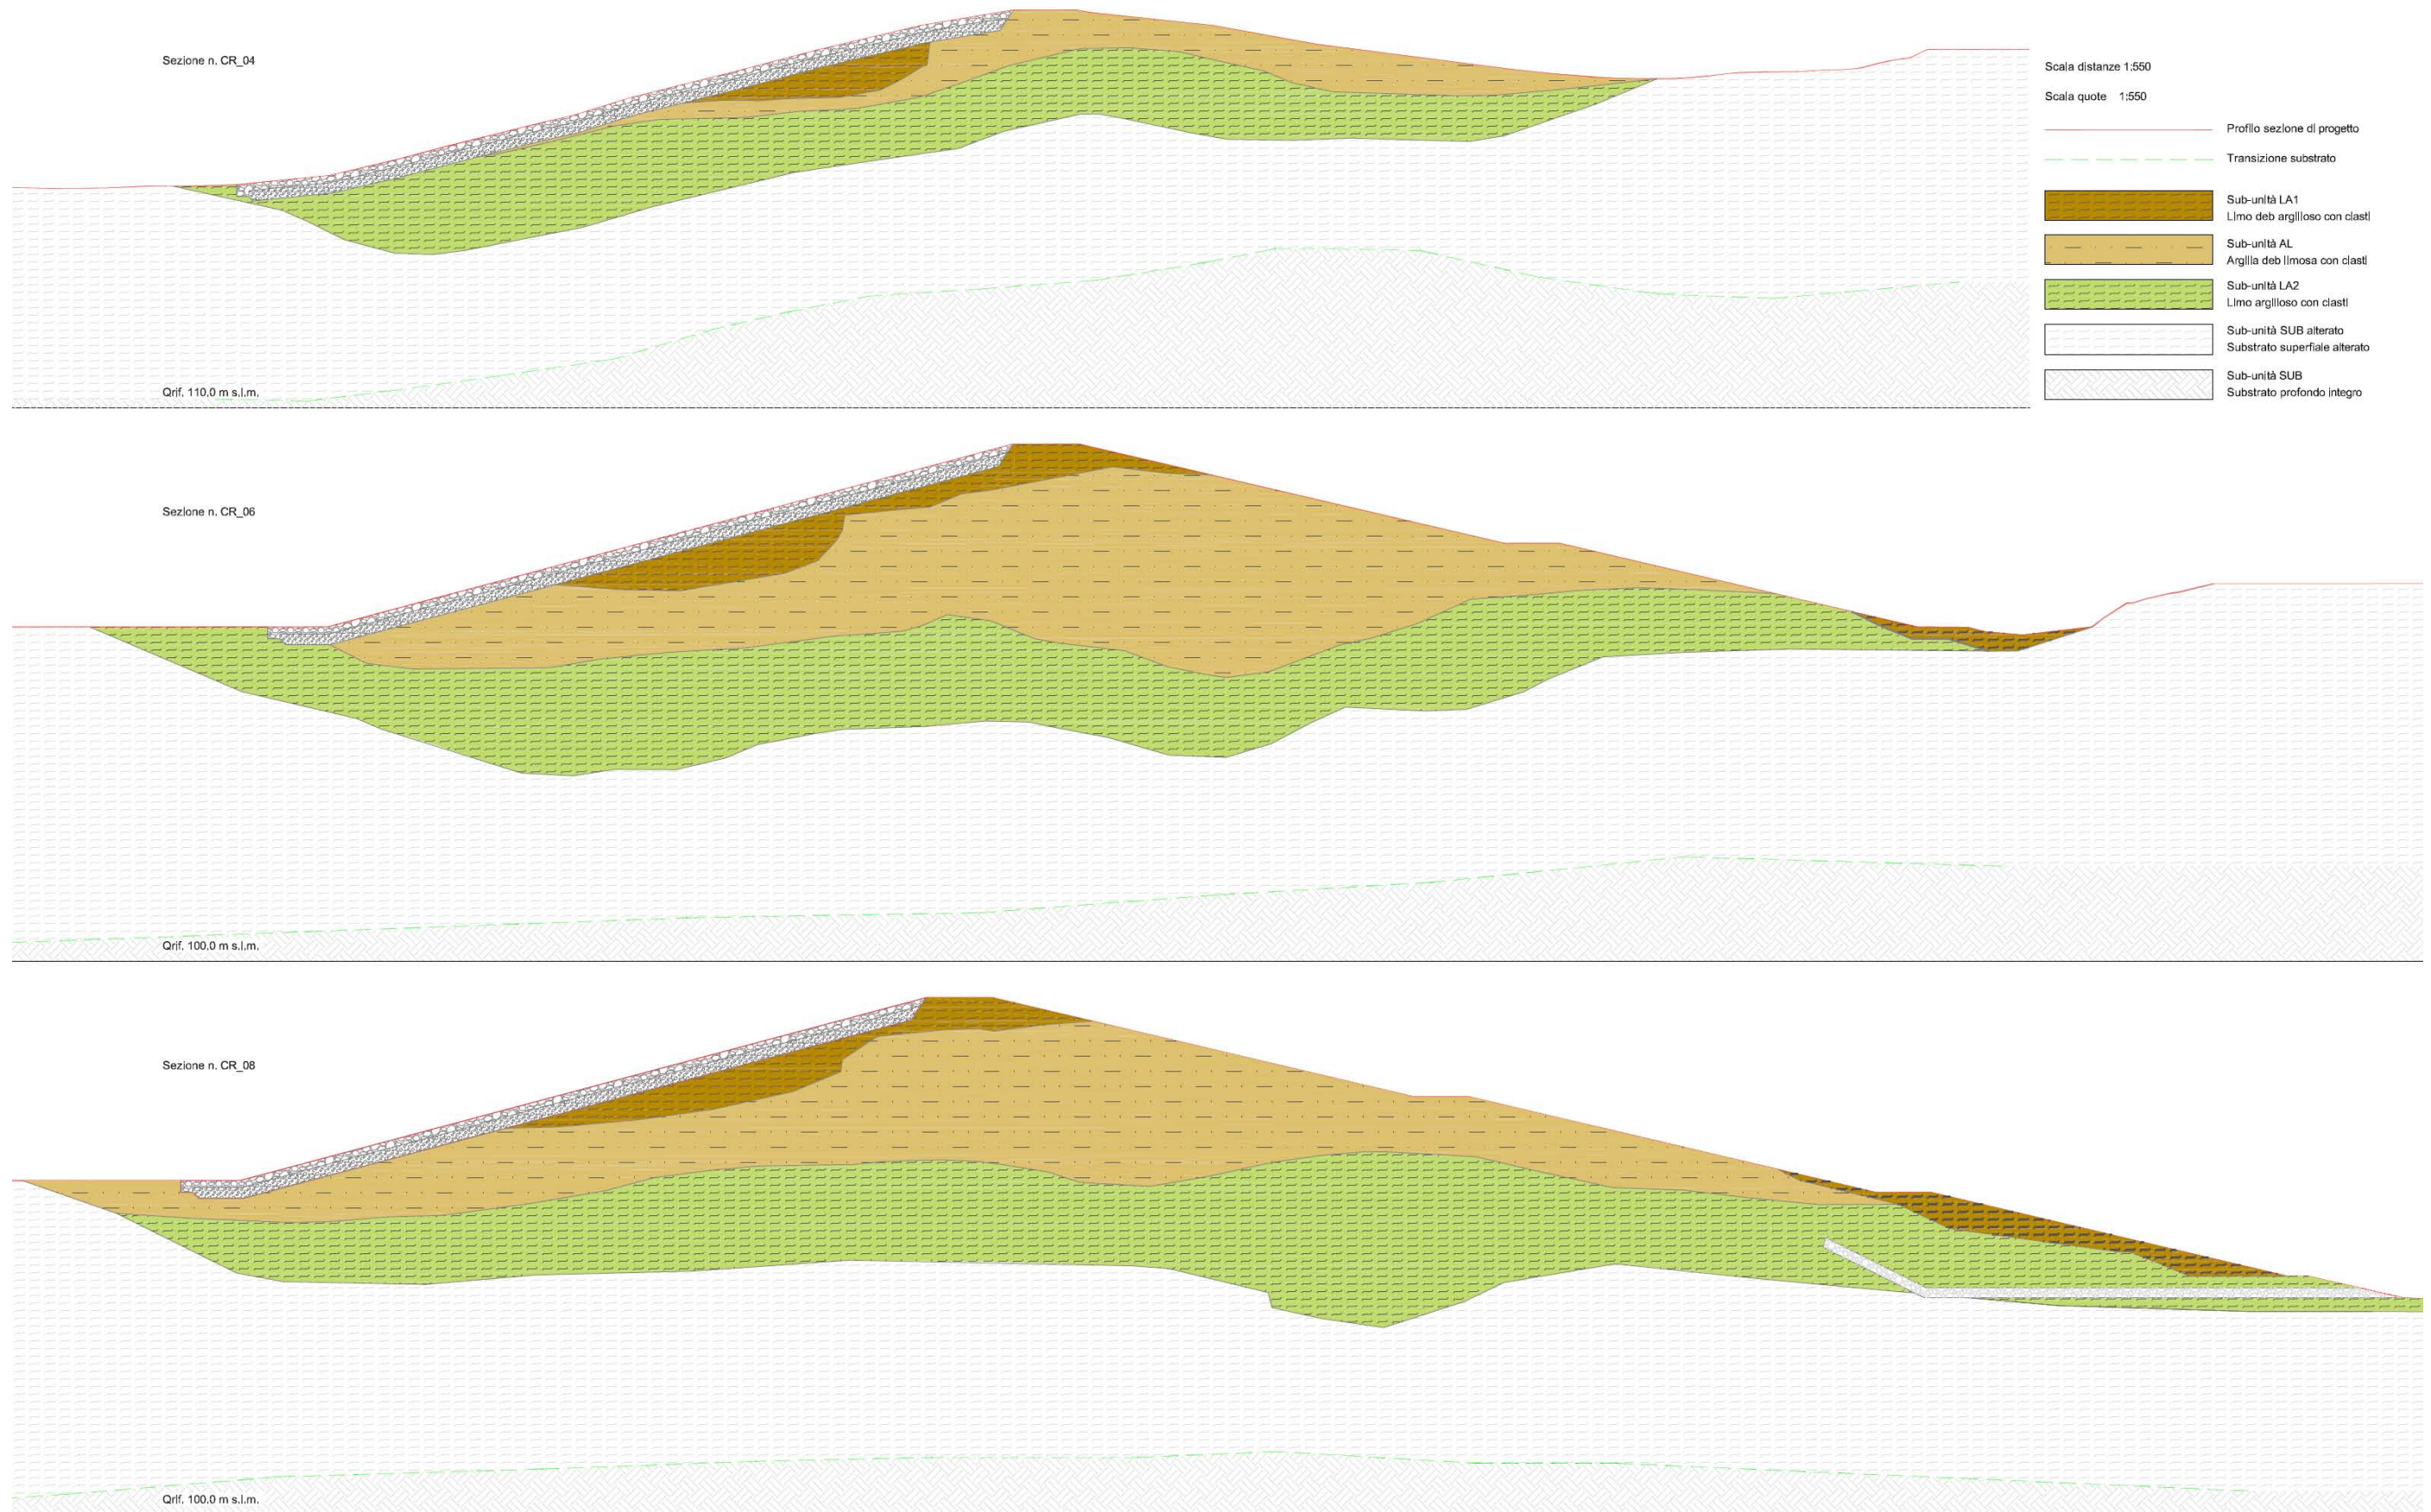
Profilo stratigrafico sezioni di progetto
